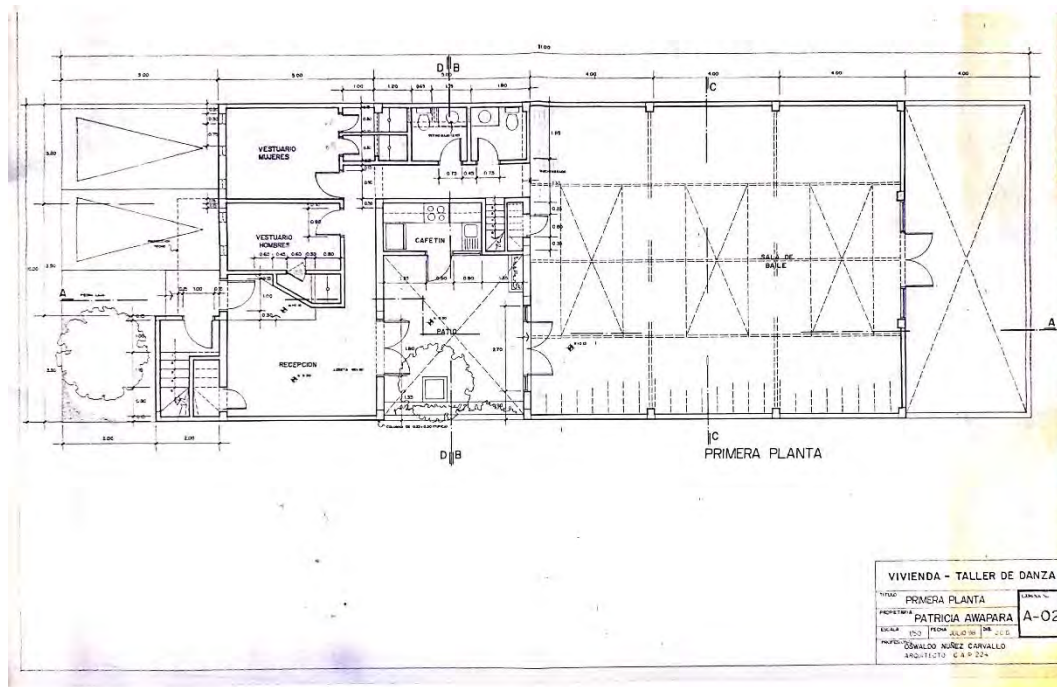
Planta arquitectónica de primer nivel de Espacio Danza. Año 1998. Fuente: Planos arquitectónicos de Oswaldo Núñez.
